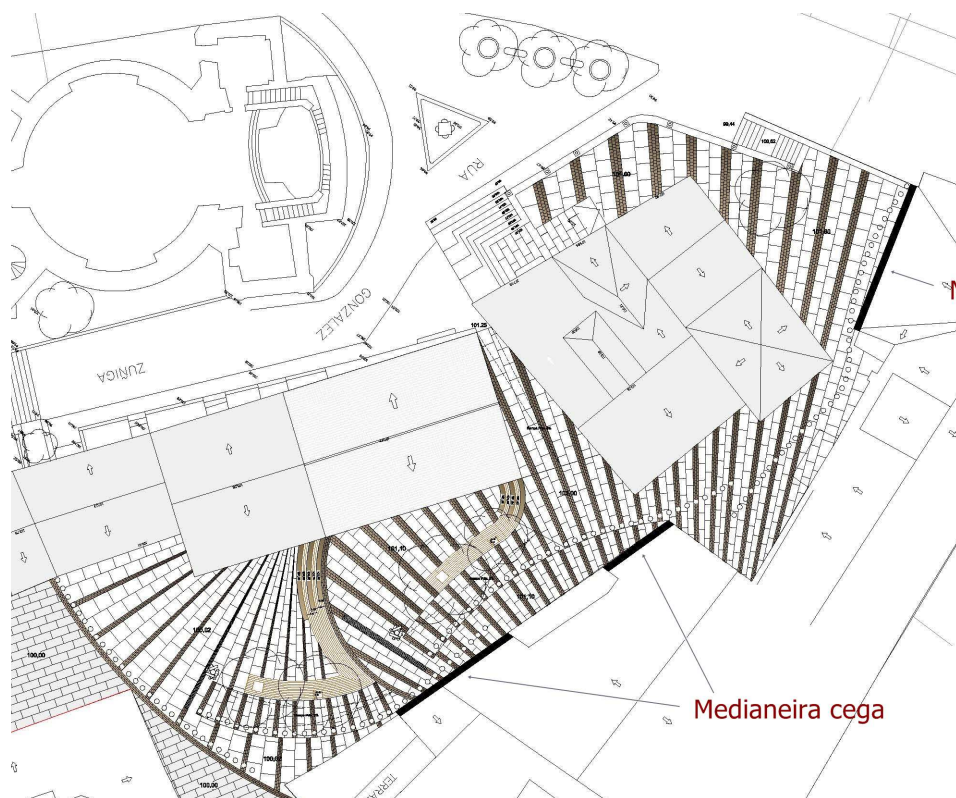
Plano da proposta indicando os distintos pavimentos propostos (imaxe de autor)
